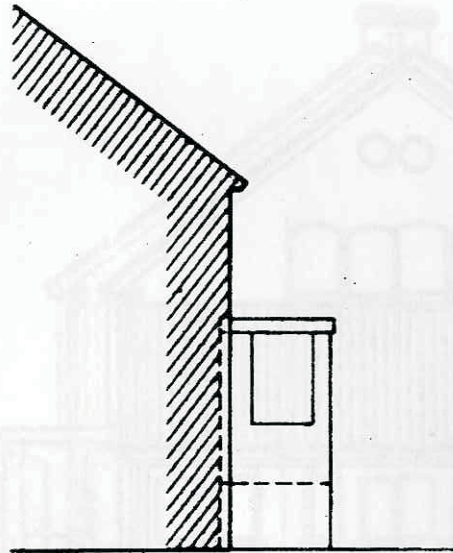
Offener Vorbau (rückwärtige Ansicht)
